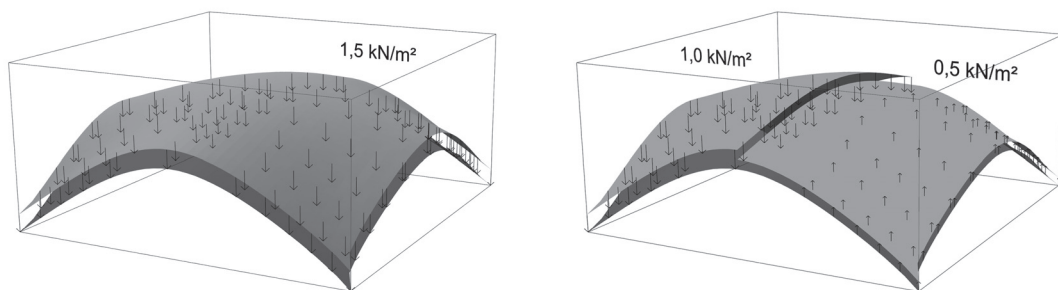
Adaptive Stahlbetonschale — Belastung
